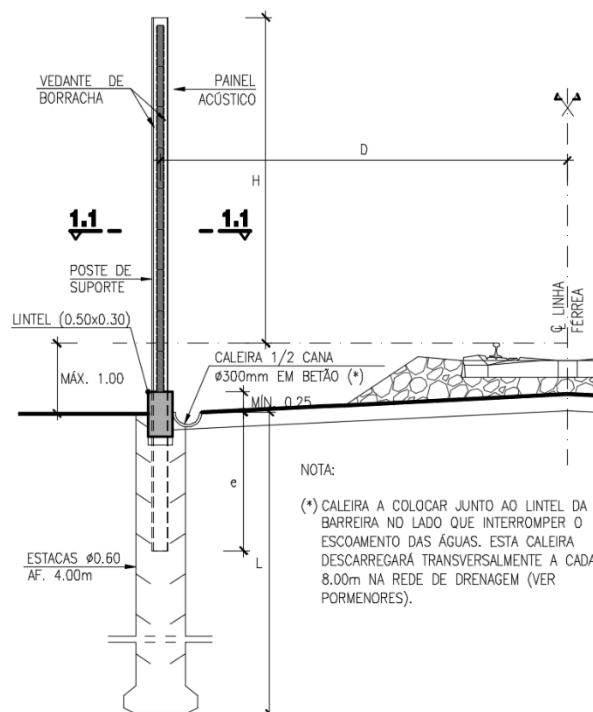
Secção Transversal. Tipo das Barreiras Acústicas
